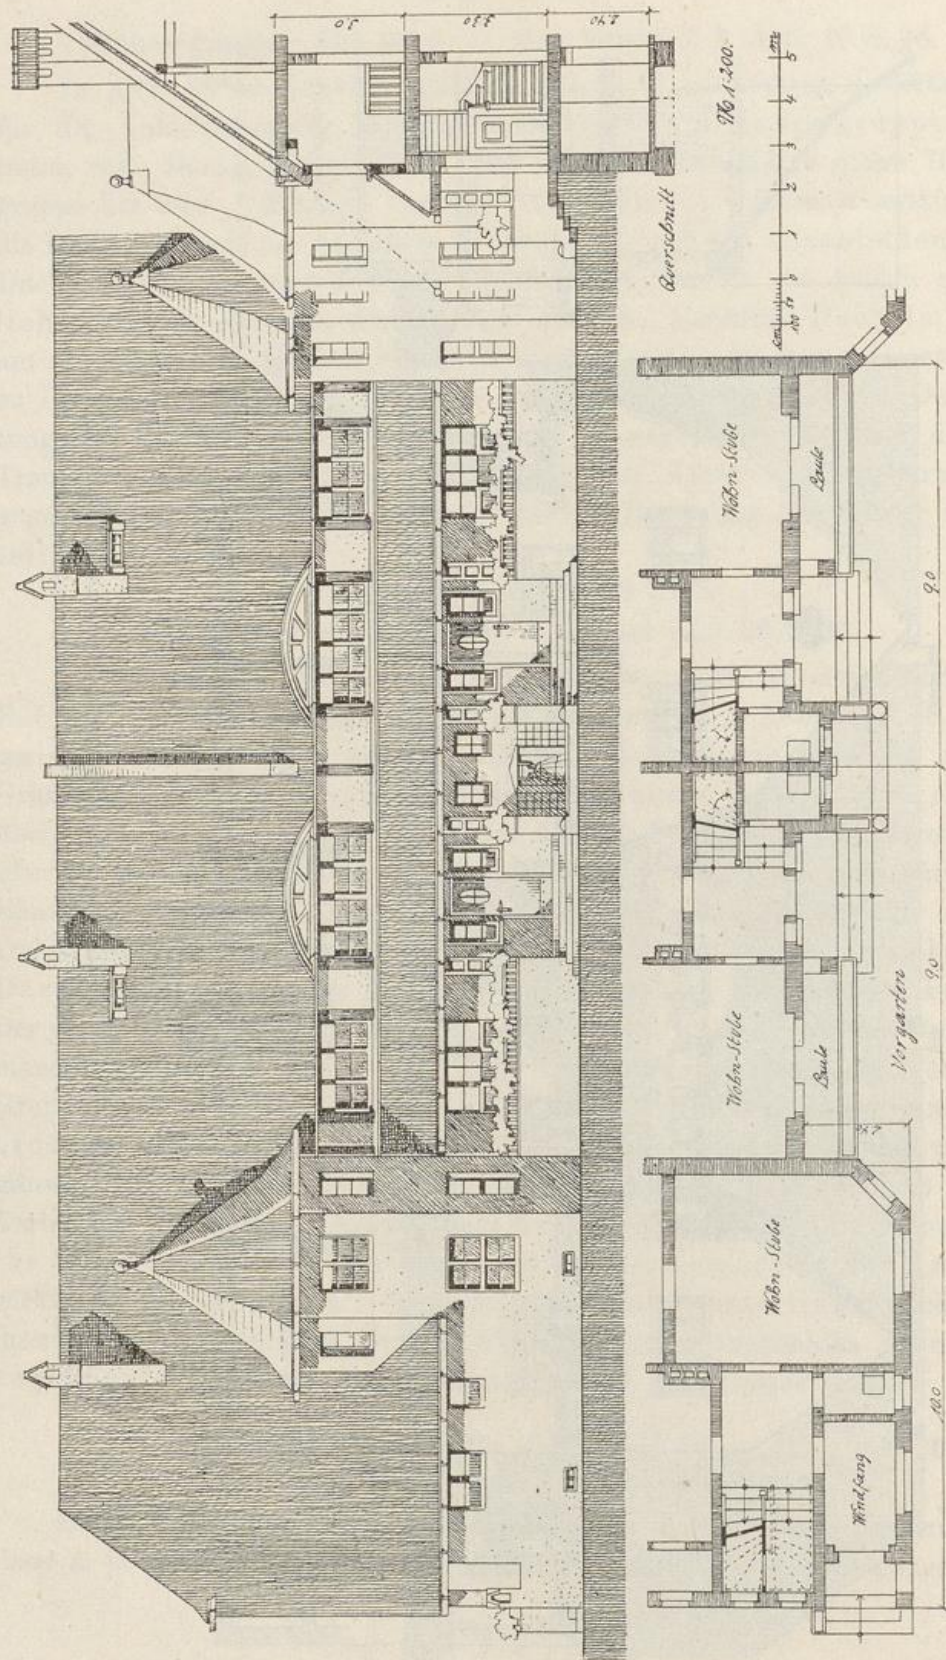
Vierhäusergruppe mit Betonung der Eckhäuser durch Vorziehen. Hierzu Grundriß A Abb. 46 S. 48.
